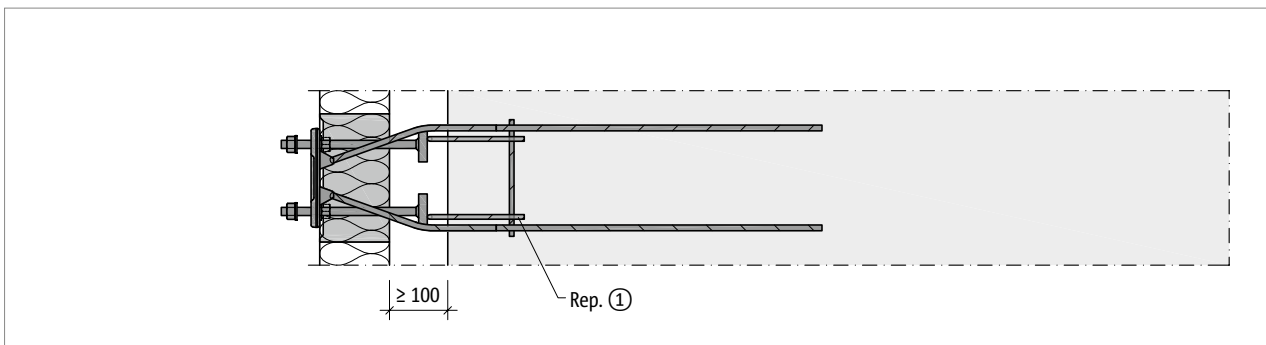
Schöck Isokorb® XT type SQ : armatures à prévoir par le client dans le cas d'une construction en prédalle, vue en plan
